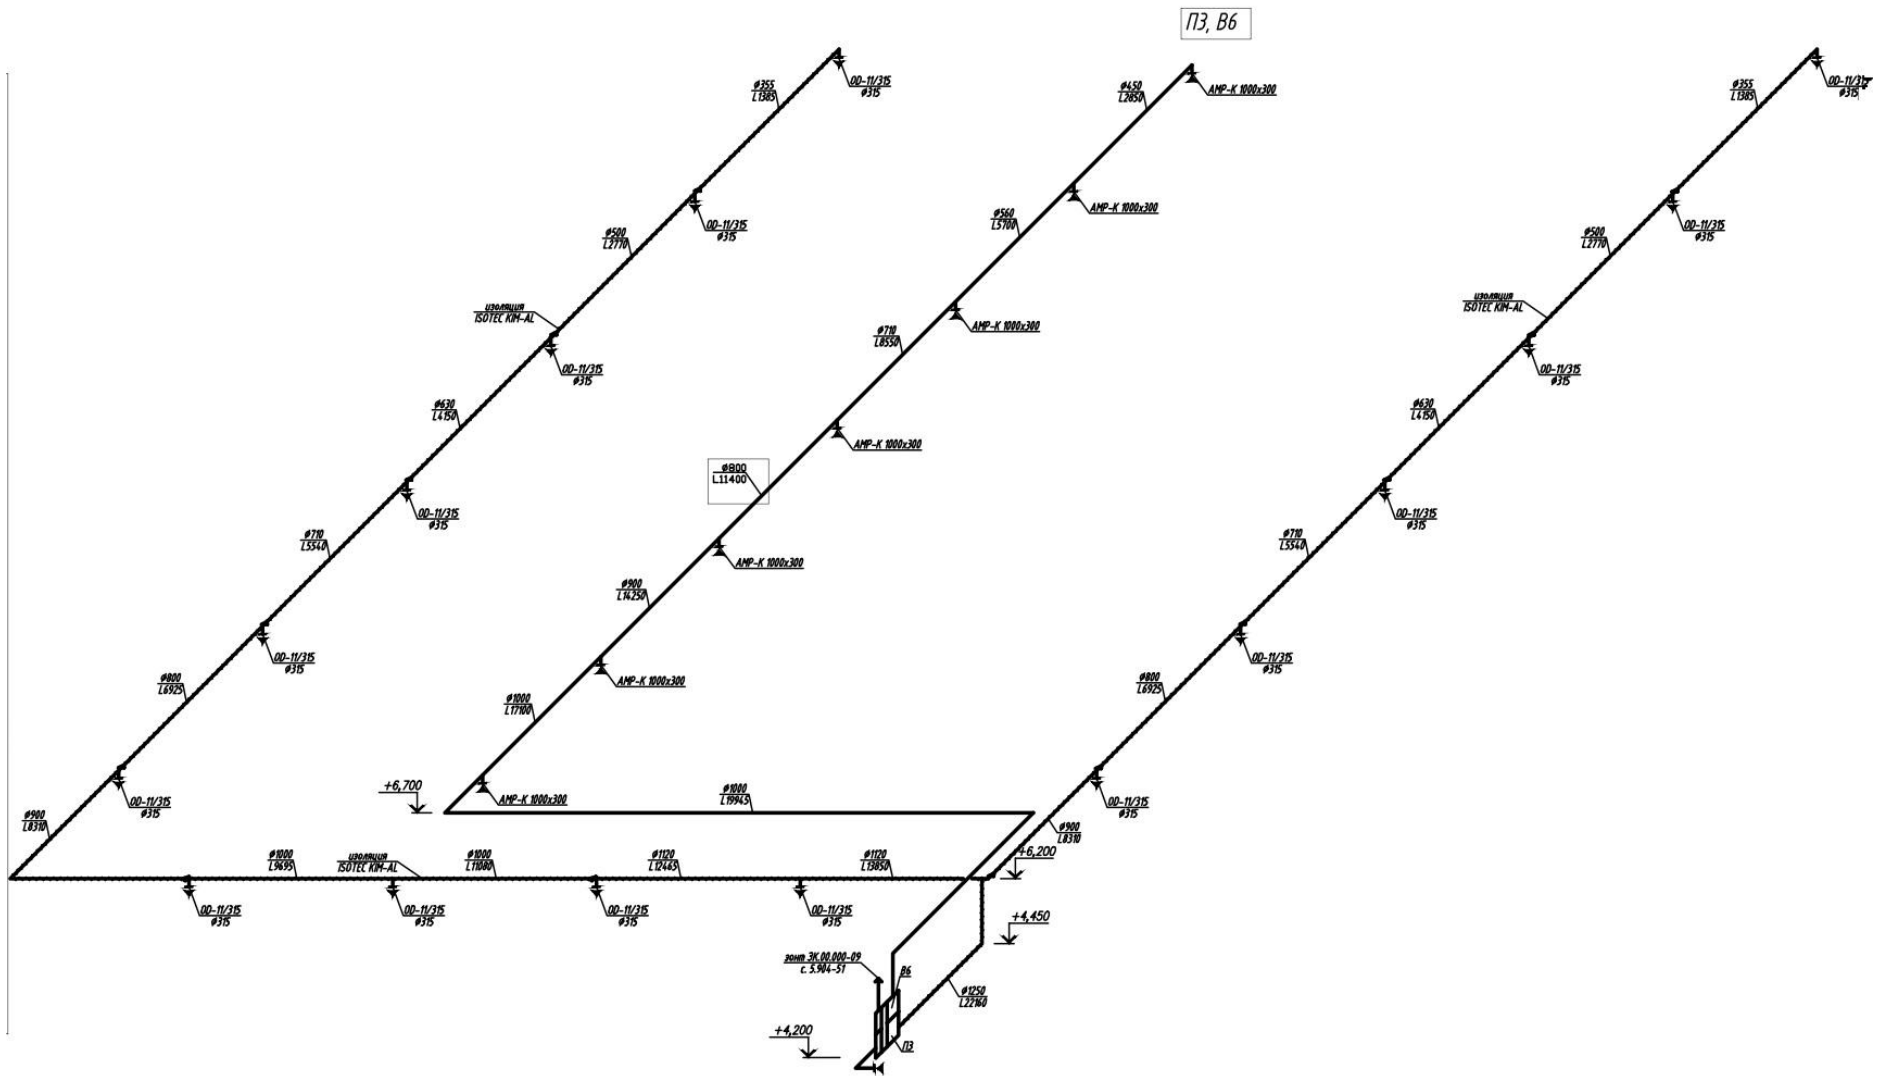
Расчетная схема системы вентиляции ПЗ и В6
